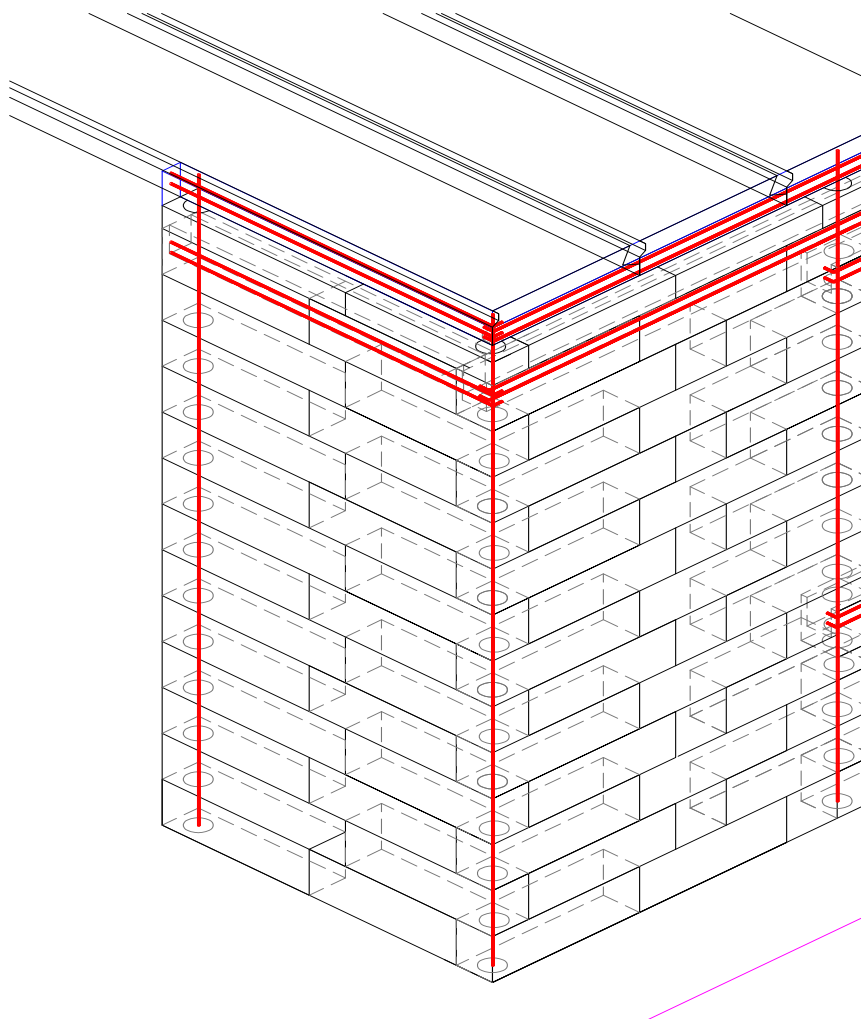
Detalle del block tipo “O”, como refuerzo vertical, para cargas laterales.
